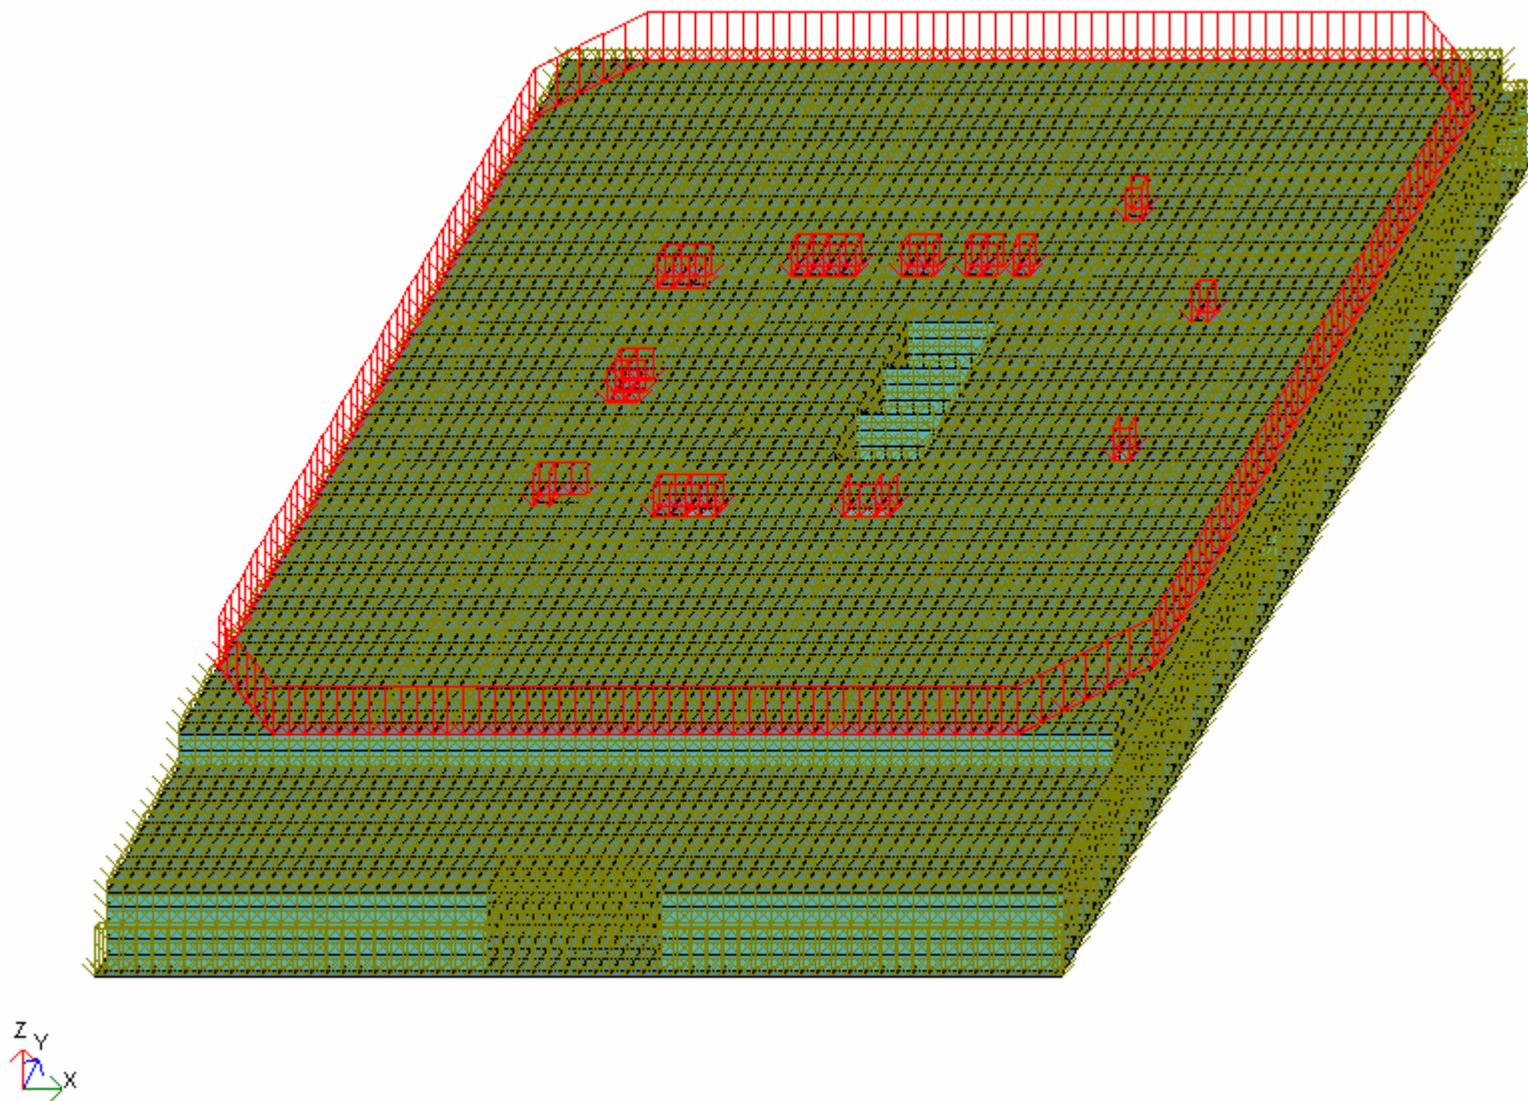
Действие ограждений и кладки вент. каналов на перекрытие первого этажа
